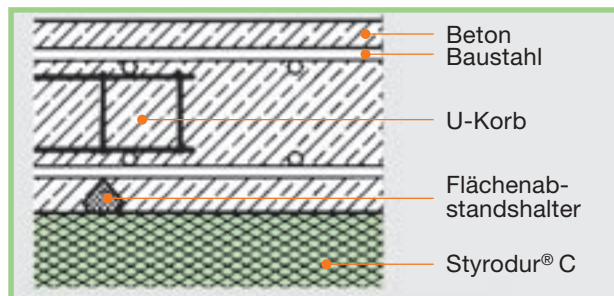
Begehbarer Flächenabstandshalter aus Faserbeton für die untere Bewehrung und Baustahlgewebeunterstützungskorb für die obere Bewehrung der Bodenplatte.
